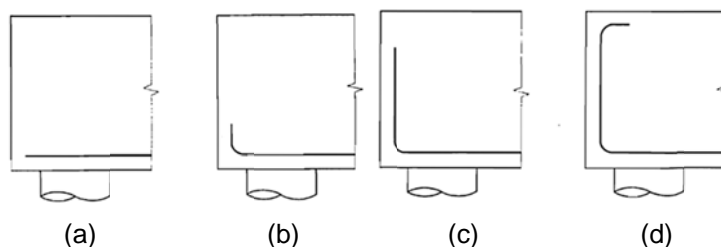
Ancoragem das barras das armaduras principais: (a) reta, (b) gancho curto, (c) gancho até a face superior do bloco, (d) gancho até a face superior do bloco mais gancho na extremidade
